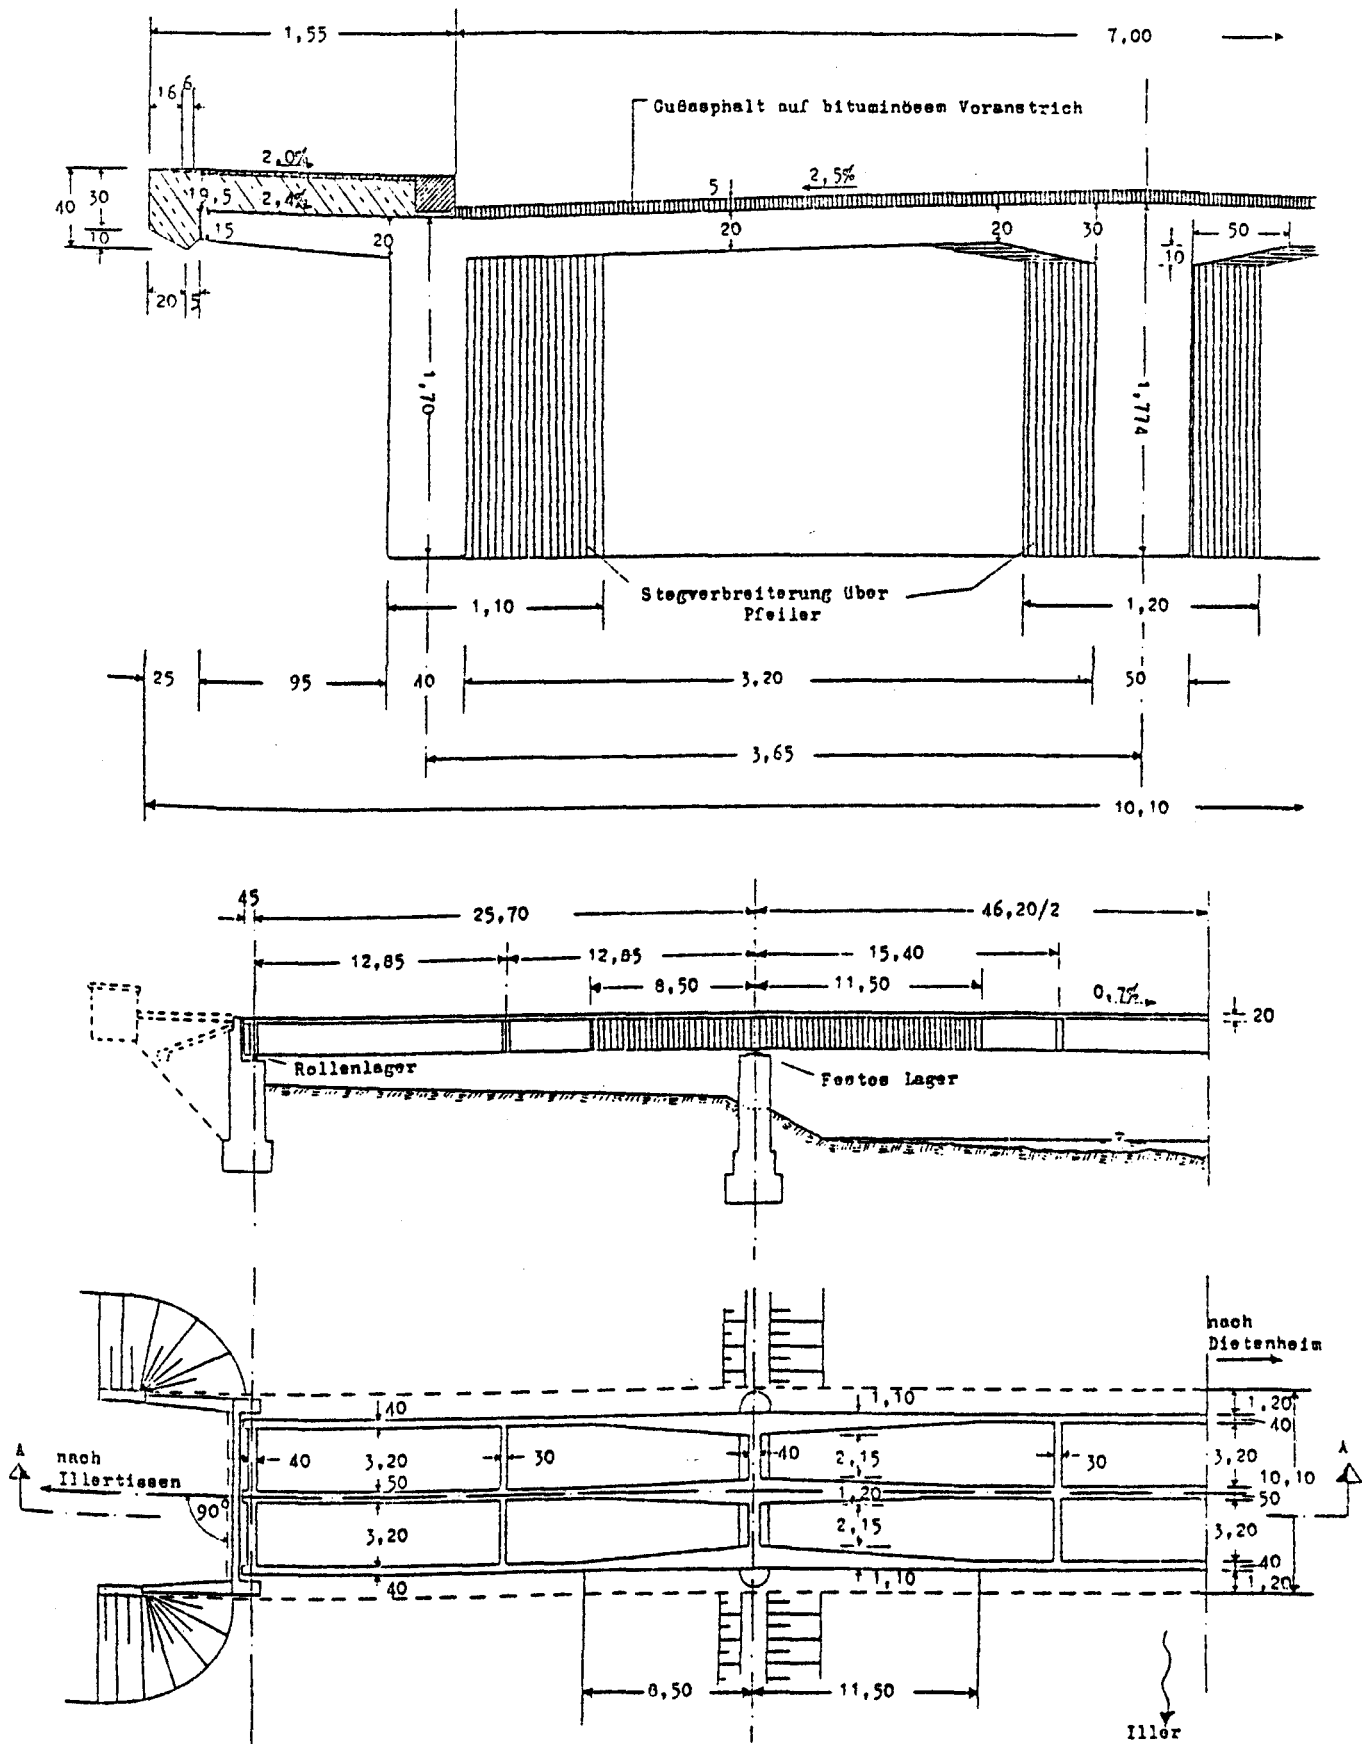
Brückenquerschnitt, Längsschnitt und Grundriß der Illerbrücke
